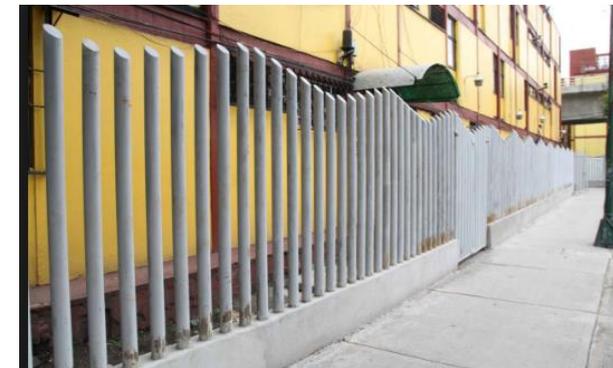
Barda perimetral de concreto con perfiles tubulares
